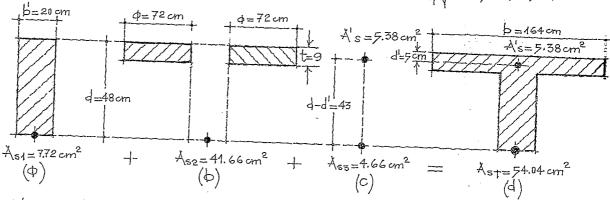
44. Viga simplemente armada, (4). Fig. 5. 45. Patines de con creto y area de acero en tensión, (6).
